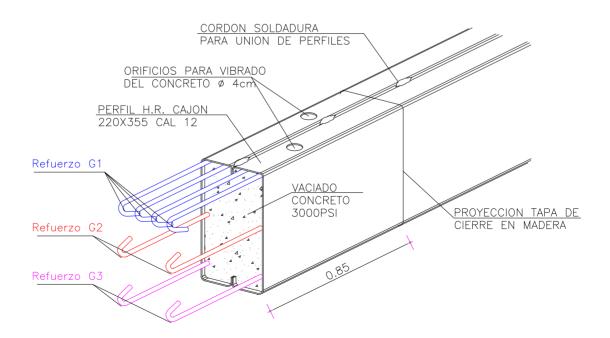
Armadura de bastones de refuerzo por cortante y perfil pintado con anticorrosivo
